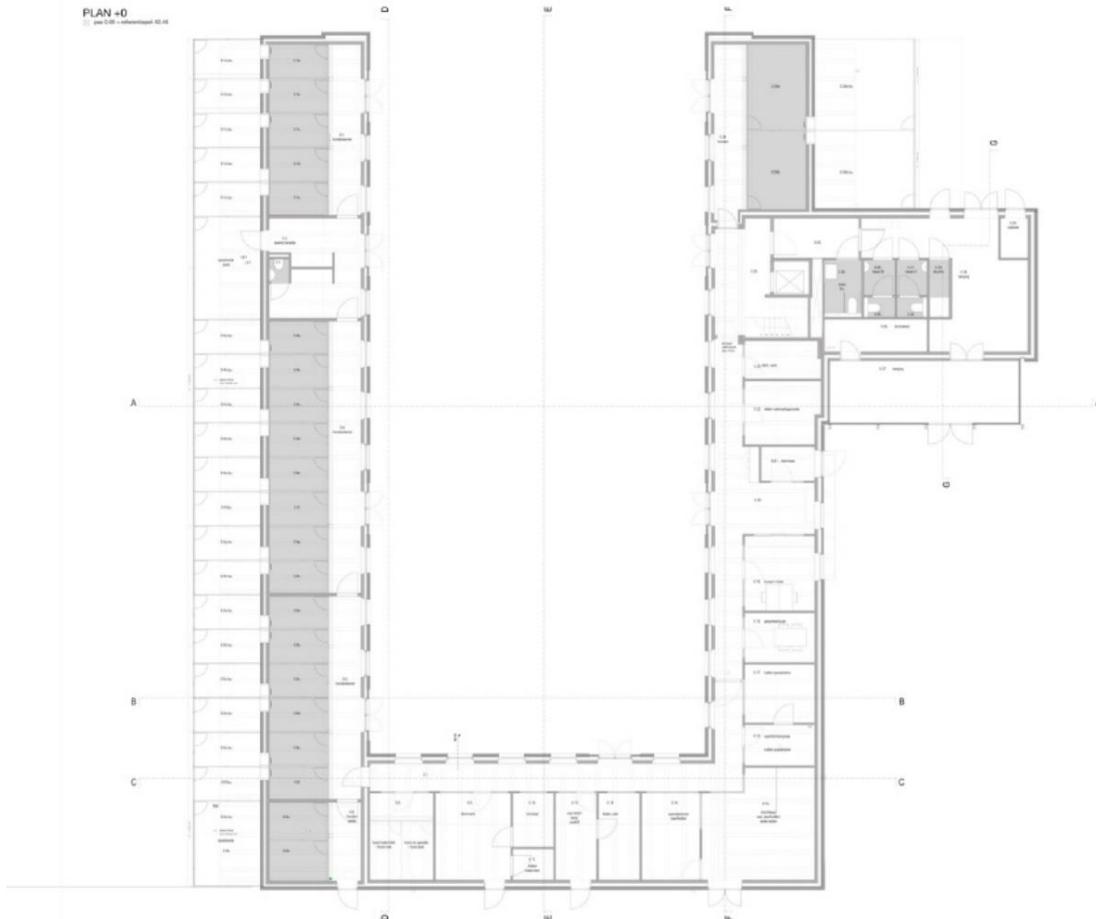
Planta Arquitectónica Nivel 0 del Refugio para animales y crematorio de mascotas Lommel, Collectief Noord, 2021, Archdaily. [Plano]
